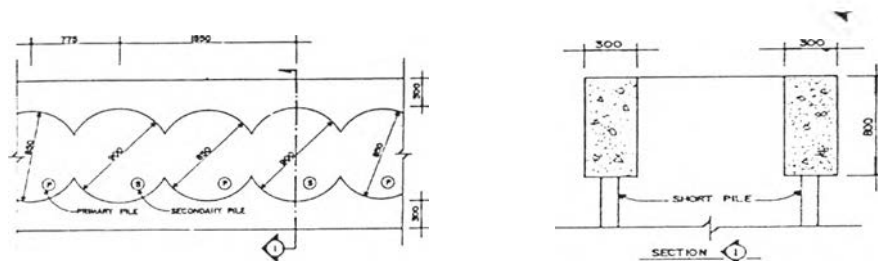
แสดง Cement Bentonite Secant Pile Wall
